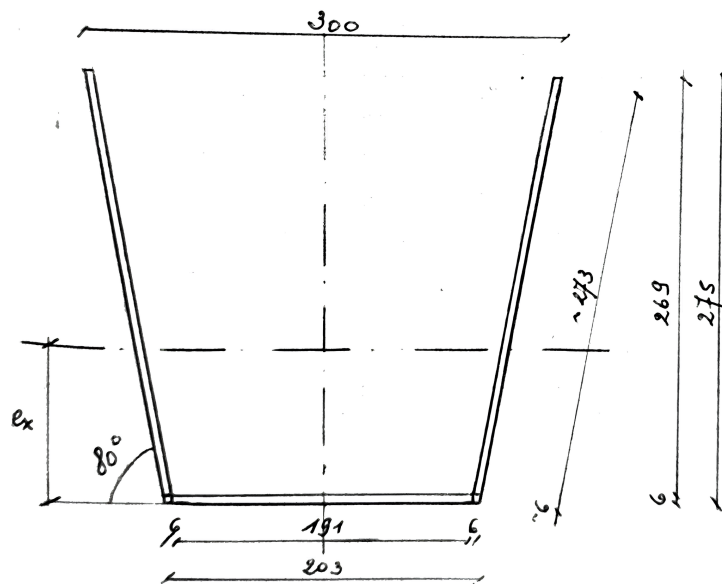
Schéma d'un auget de la dalle orthotrope du pont de Haccout.
